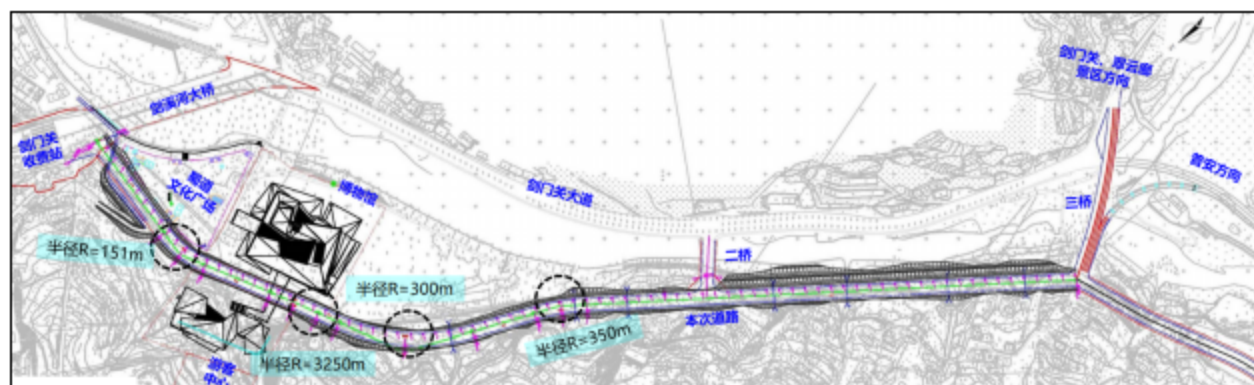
配套基础设施(道路)项目道路平面布置示意图
